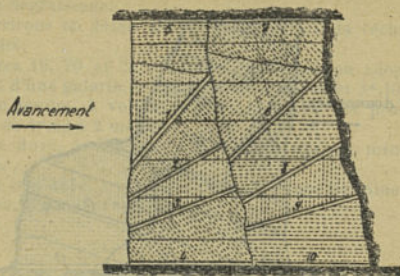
Bancs horizontaux (coupe longitudinale).
